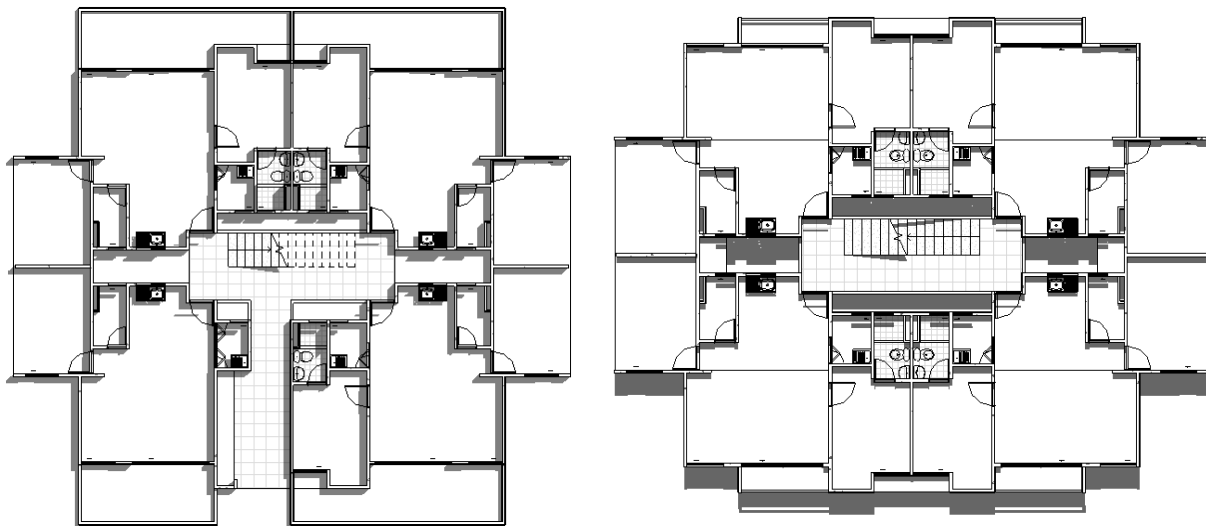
Planta nivel 1 / planta nivel 2 a 4
